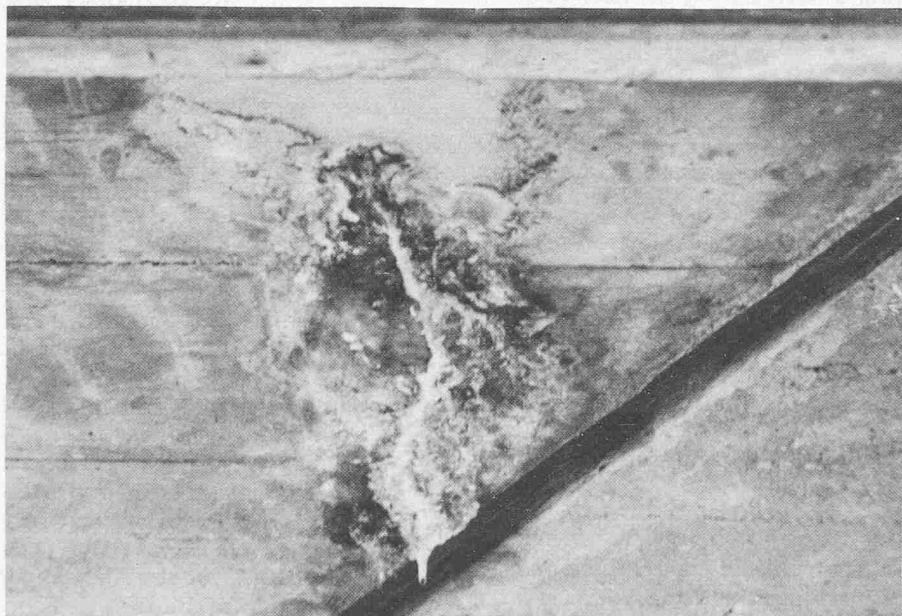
Kalkausschwemmungen durch Riss im Beton der Brückenfläche
